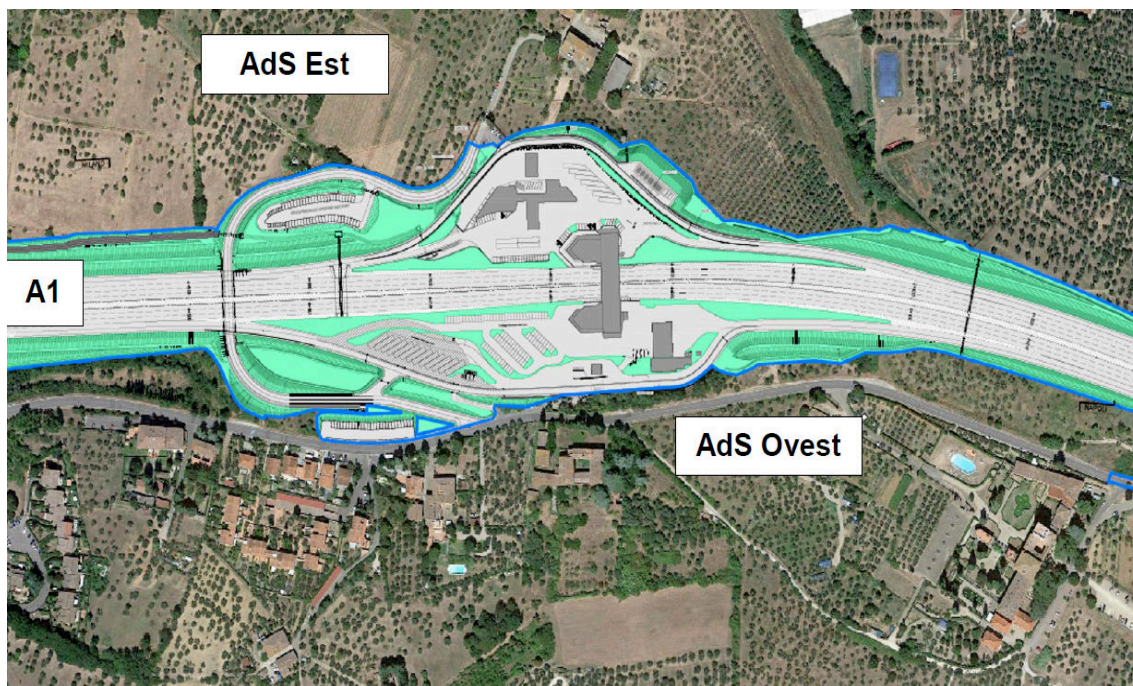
Planimetria soluzione progettuale alternativa (Fonte: lista di controllo)
